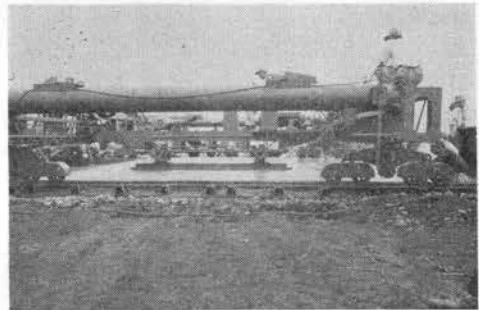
コンクリートレベリングフィニッシャ丸善舗道
